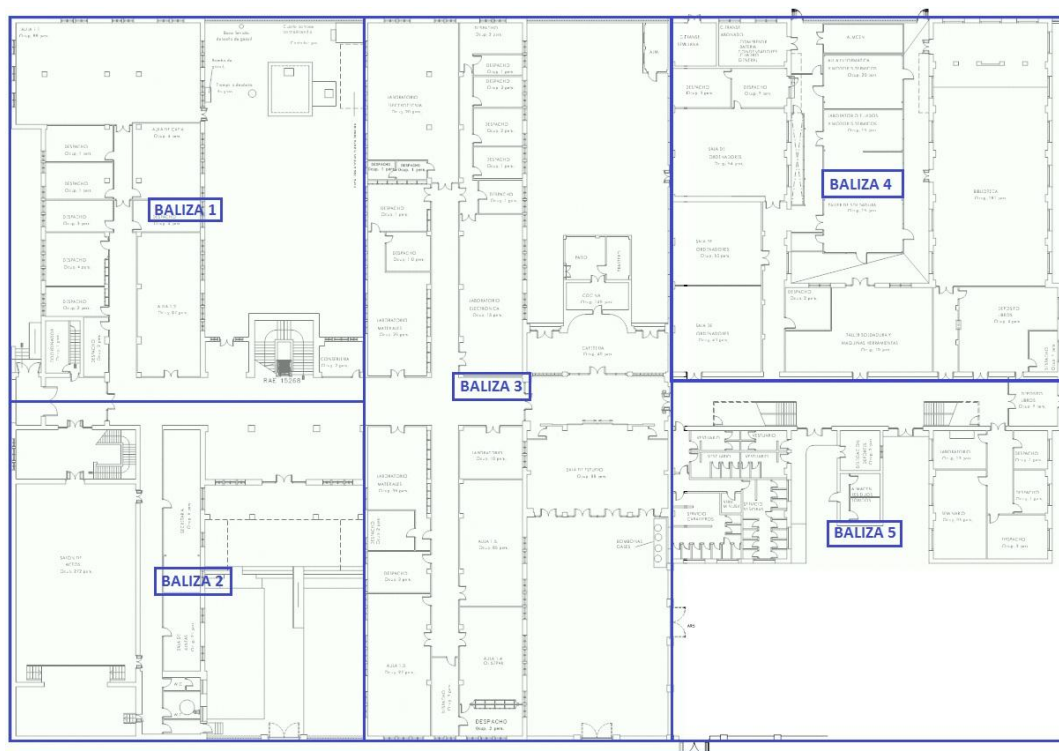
Plano balizas planta baja con sectorizado entre plantas
